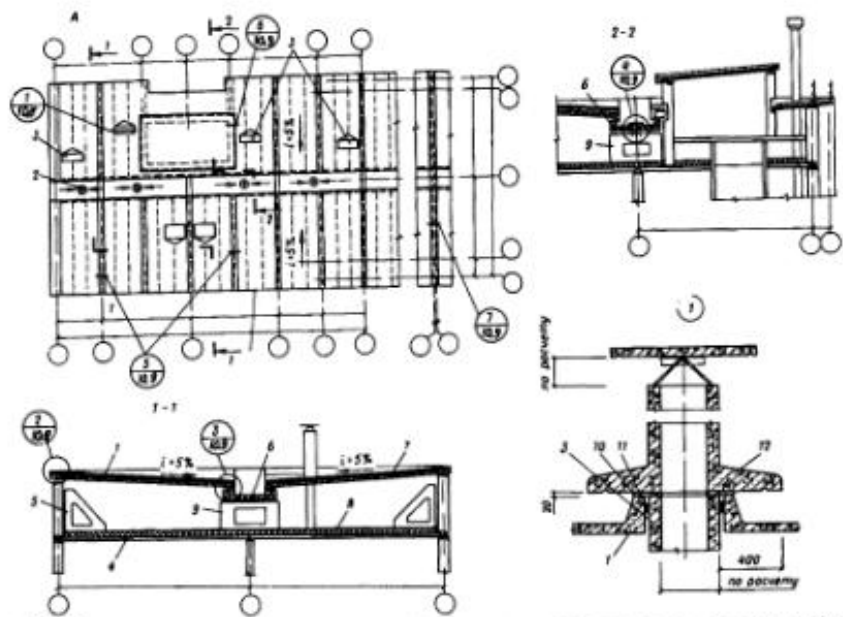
Безрулонная крыша с холодным чердаком и внутренним водоотводом (тип Б): А – схема-план крыши; 1 – кровельная панель; 2 – водосточная воронка; 3 – вентиляционный блок; 4 – панель чердачного перекрытия; 5 – опорный элемент фризовой панели; 6 – лотковая панель; 7 – П-образная плита – нащельник; 8 – утеплитель; 9 – железобетонная опорная рама; 10 – цементно-песчаный раствор; 11 – герметик; 12 – оголовки вентиляционного блока
